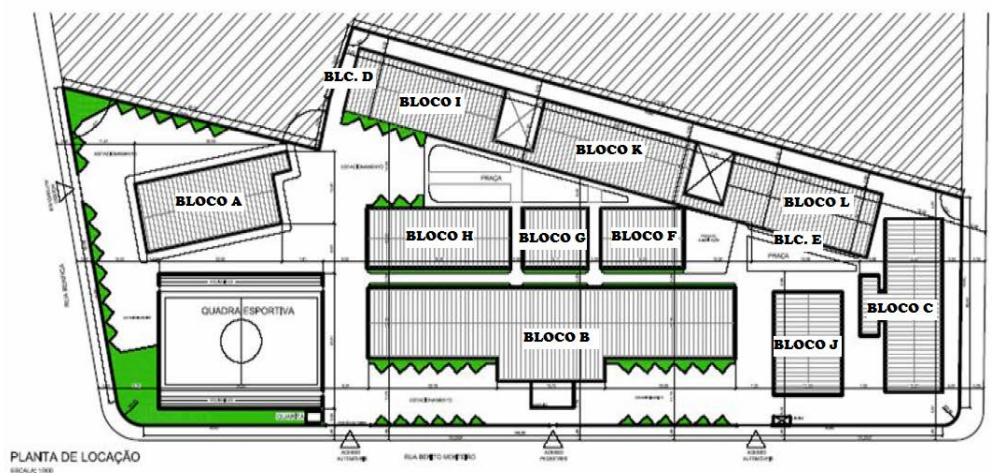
Planta de localização do campus da Escola Politécnica de Pernambuco.
